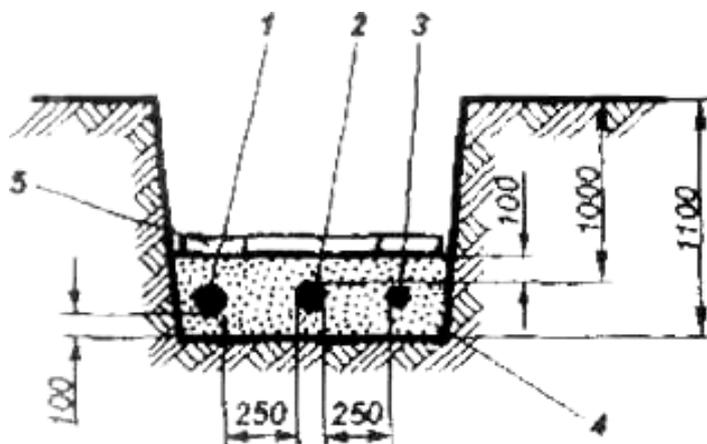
Прокладка кабелей 1...10 кВ параллельно с кабелями 35 кВ (20 кВ): 1 – кабель 20 кВ; 2 – кабель 35 кВ; 3 – кабель 10 кВ; 4 – песок; 5 – железобетонные плиты
